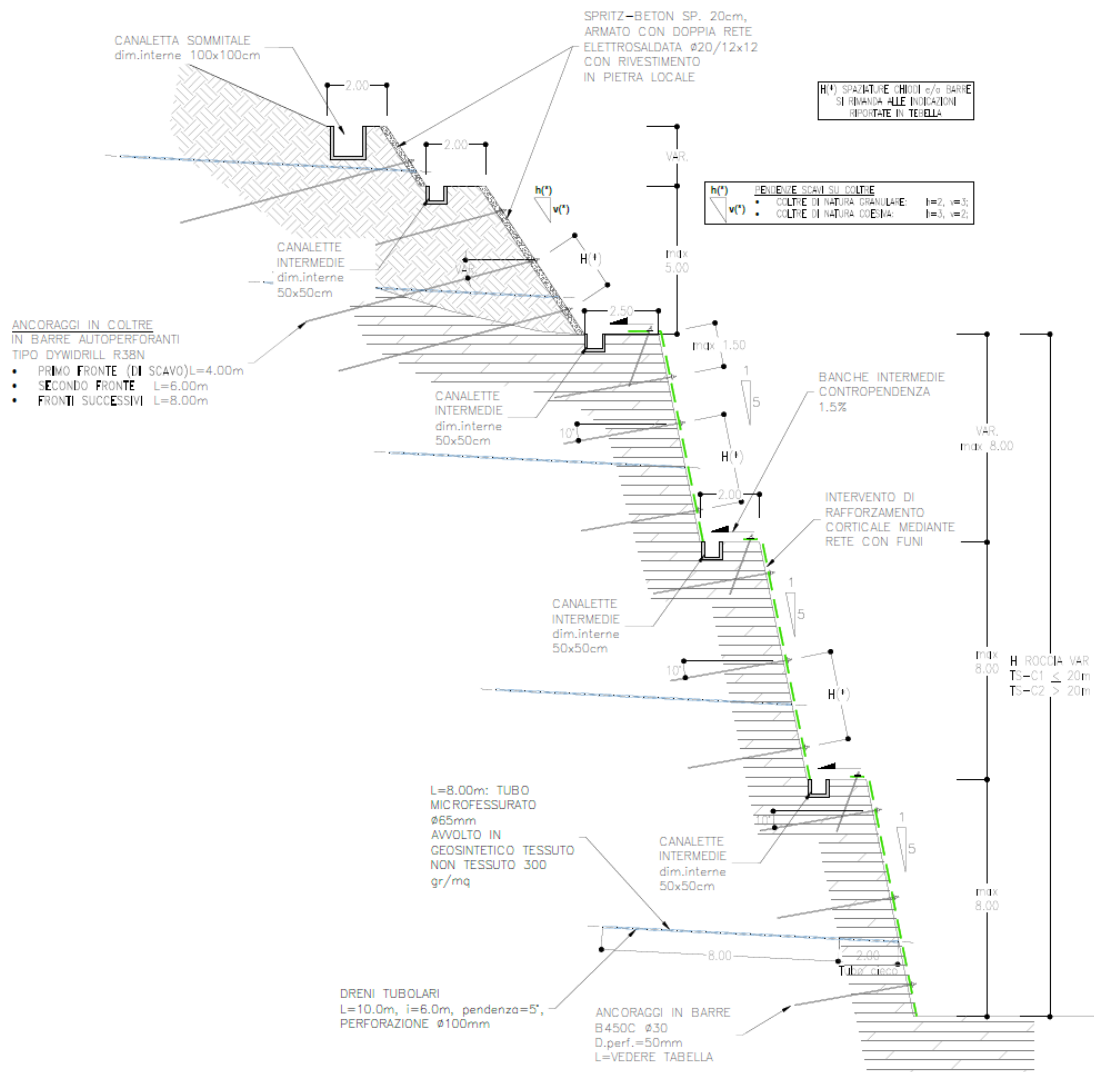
Sezione tipo scavo in roccia calcarea con copertura TS-C
